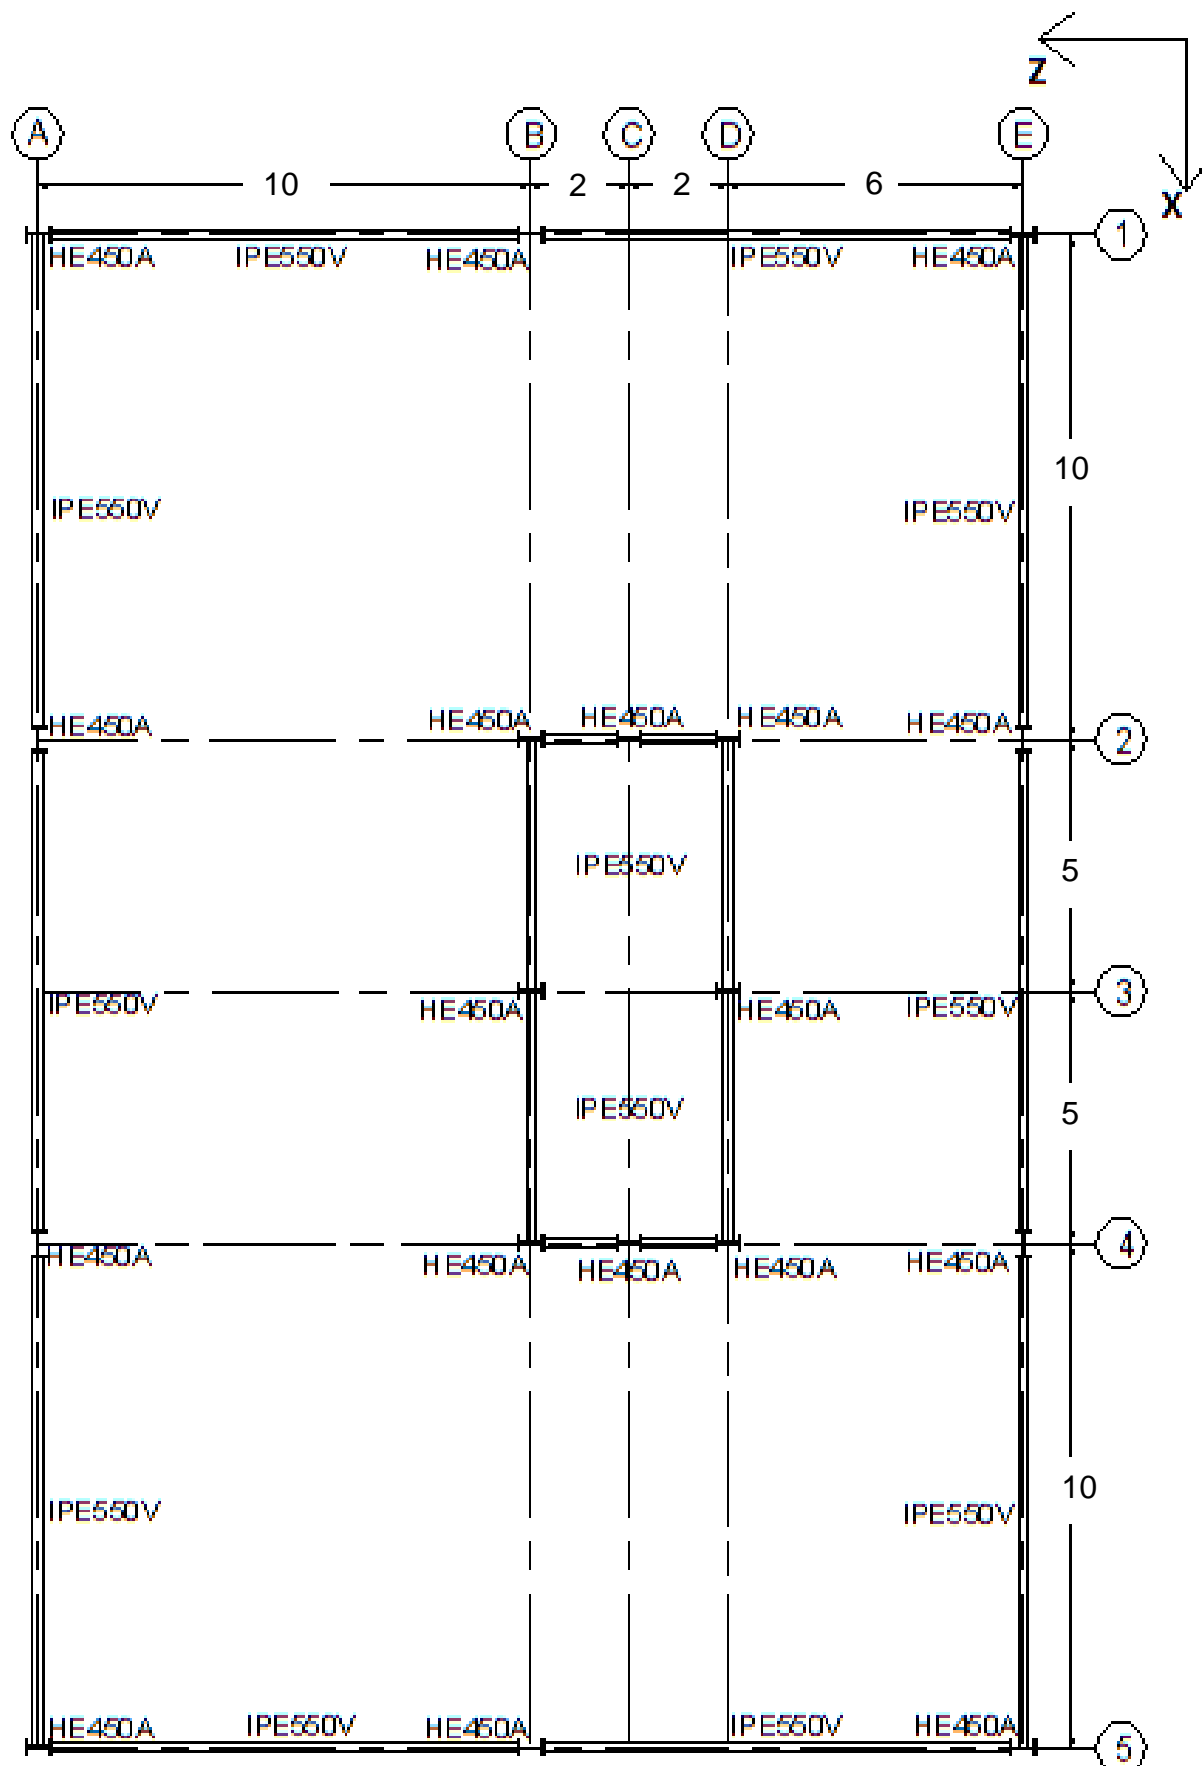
Planta do 11º ao 20º pavimento. As medidas estão em metros.
